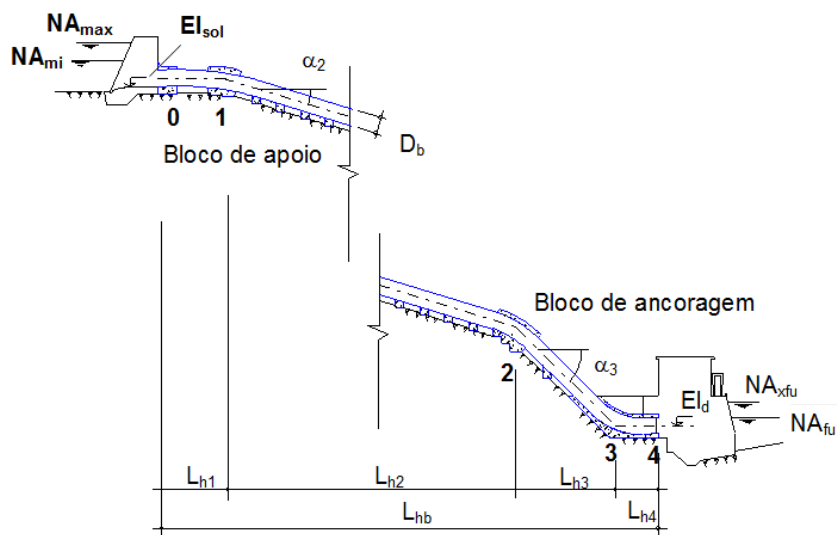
Perfil esquemático de conduto forçado com quatro trechos.
